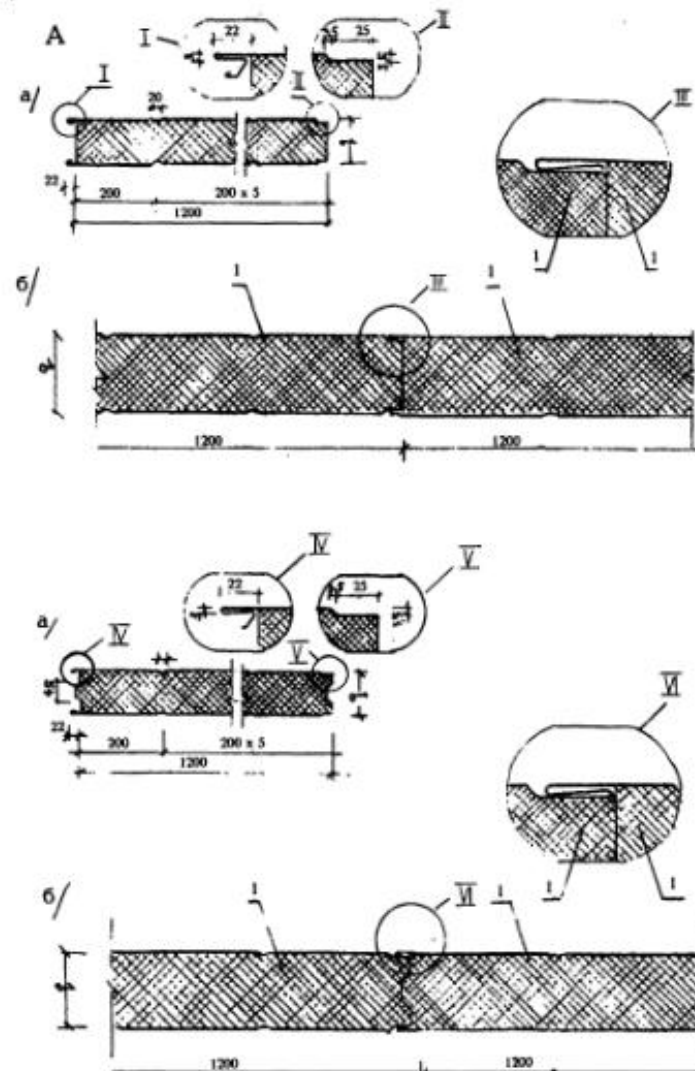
Стеновые панели "Венталл": А – тип "С1"; Б – тип "С2"; а – габаритные схемы; б – узловое соединение; q – толщина панели; l – стеновая панель
